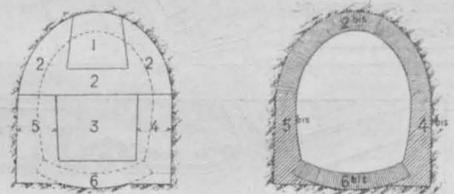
Ueblicher Bauvorgang für den Tunnelbetrieb.
